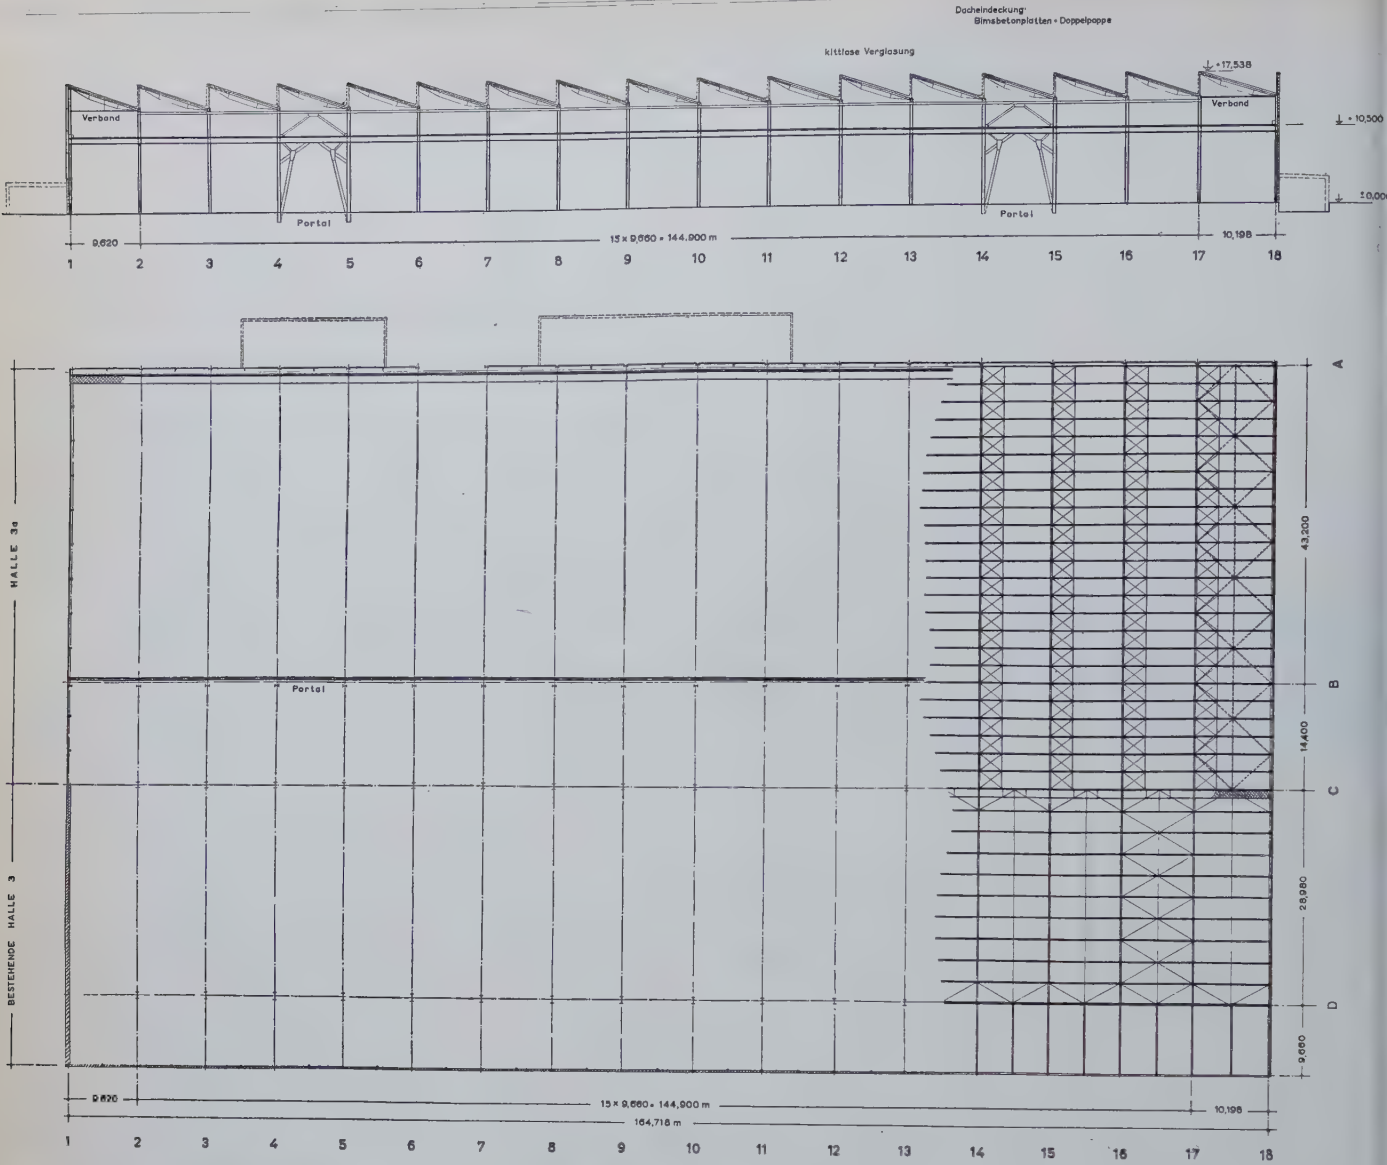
Grundriß und Längsschnitt der Halle 3 und 3 a
